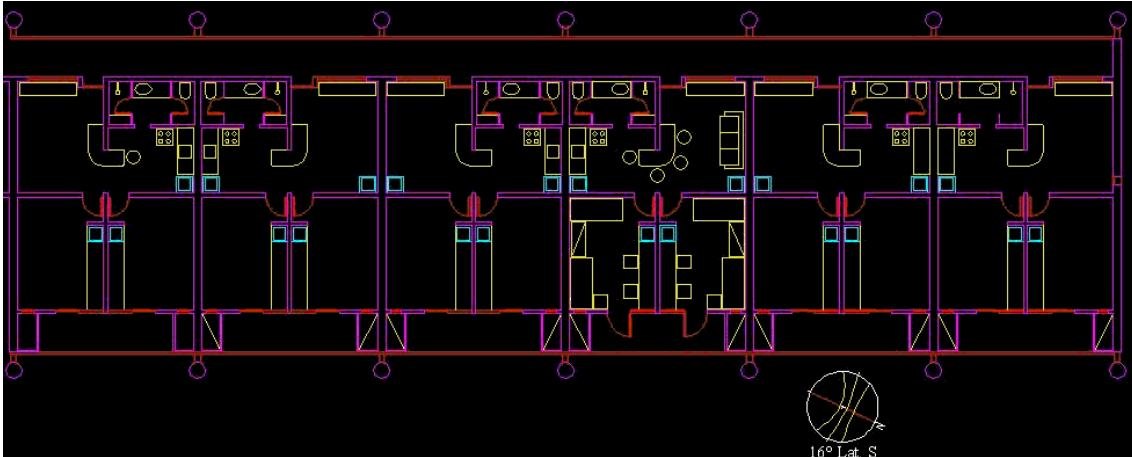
Planta baixa de com unidades de alojamentos de um pavimento na ala A do bloco K já construída. Pode-se ver os pilares cilíndricos circulares em planta, que surgiram já quando da construção da primeira ala; antes estes pilares eram metálicos em forma de X em planta. As vigas avançam e são engastadas nos pilares, em balanço sobre a circulação e varandas. Vê-se ainda a carta solar resumida na direita inferior da imagem.
